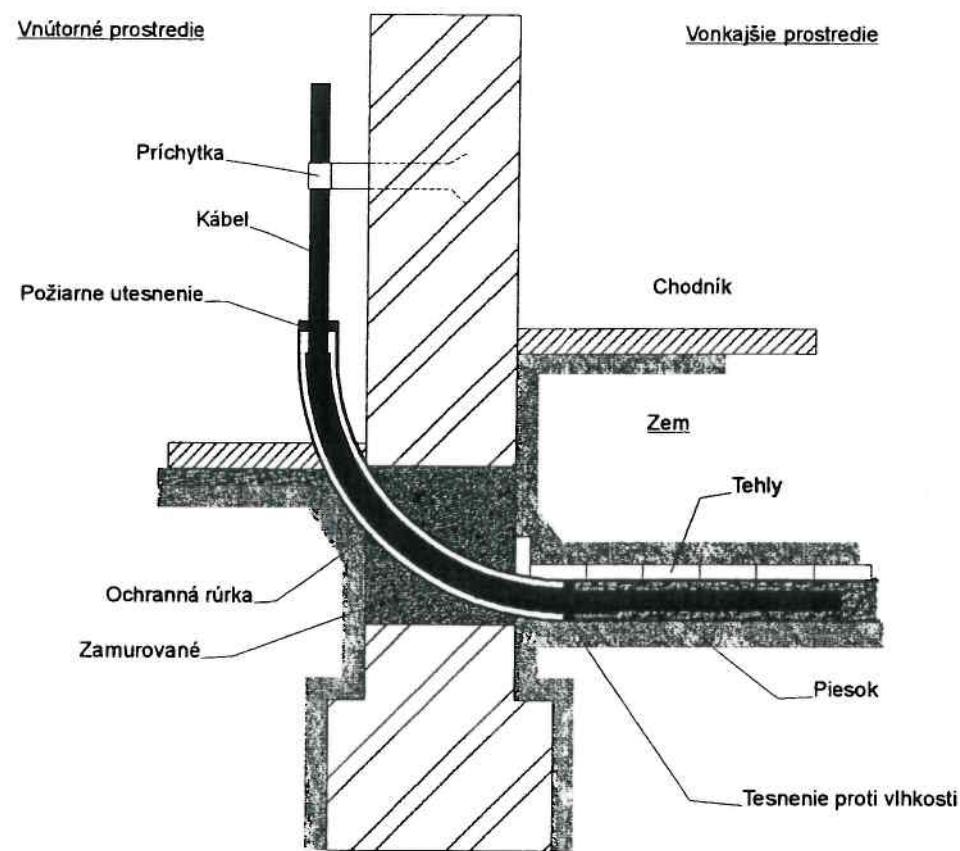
Priechod kábla z transformátorovej komory do rozvodne
